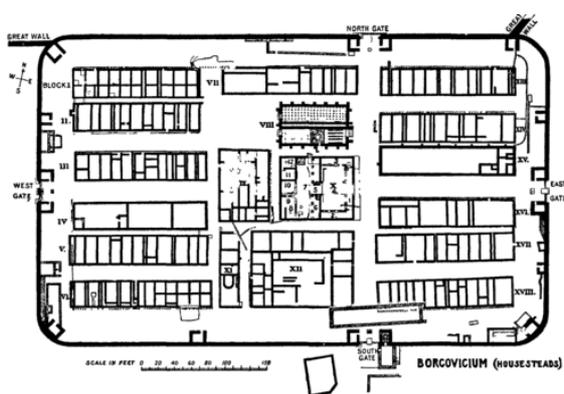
Planta de um acampamento militar Romano. Retirada do site [1]
